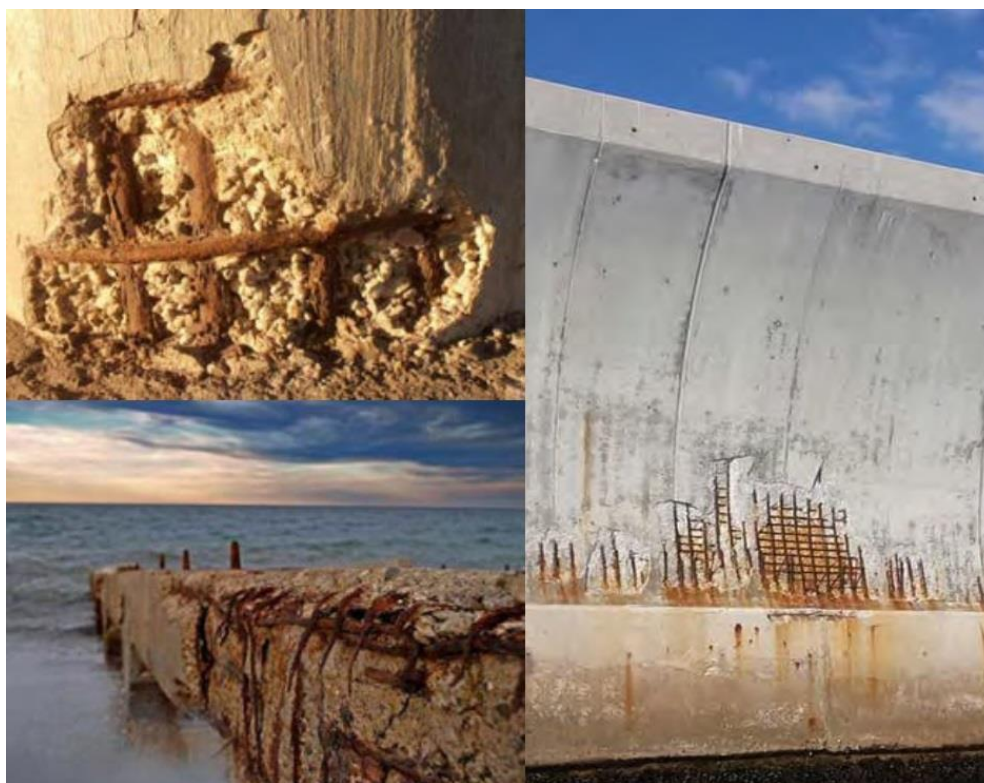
Estructuras en ambiente marino con destrucción del recubrimiento hasta la zona de armadura. (Holcim S.A.)
